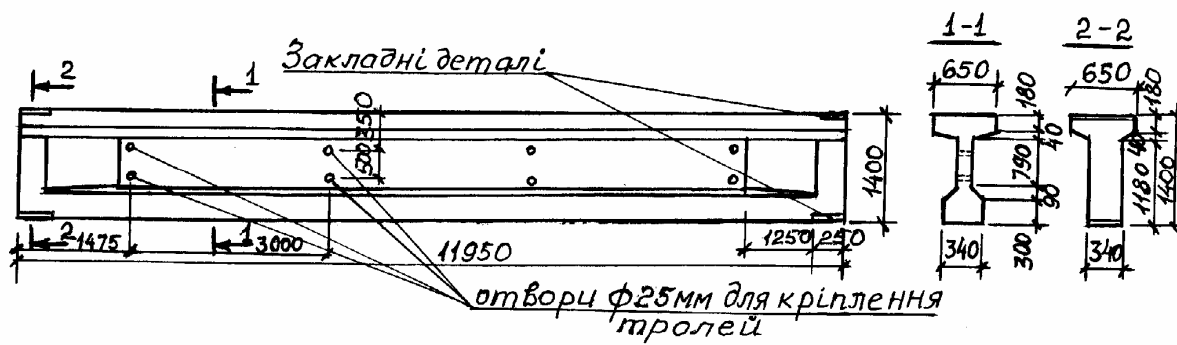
Опалубка підкранової балки прольотом 12 м
